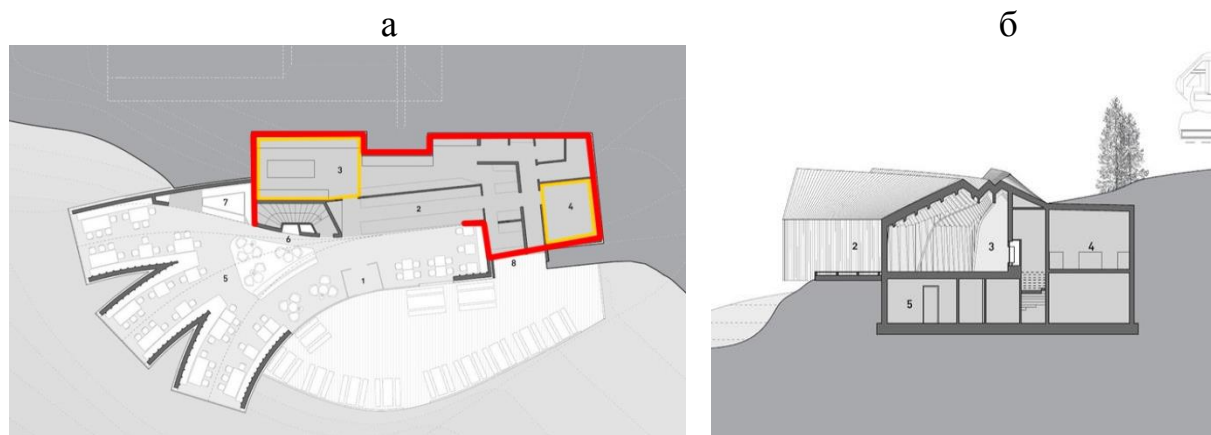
Ресторан в Италии / Oberholz Mountain Hut Peter Pichler Architecture + Pavol Mikolajcak Architekten: а – план второго этажа; б – разрез [2]
